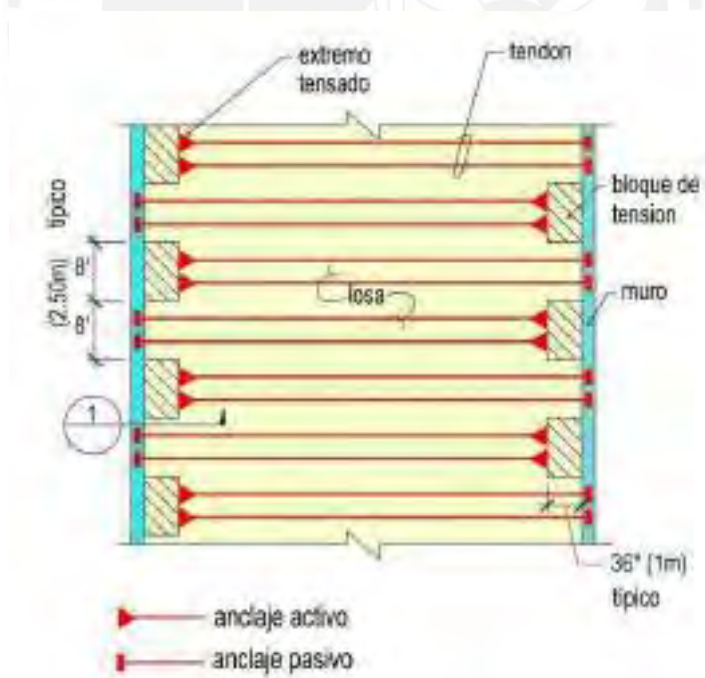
Losa entre dos paredes de sótano (ADAPT 2016)
